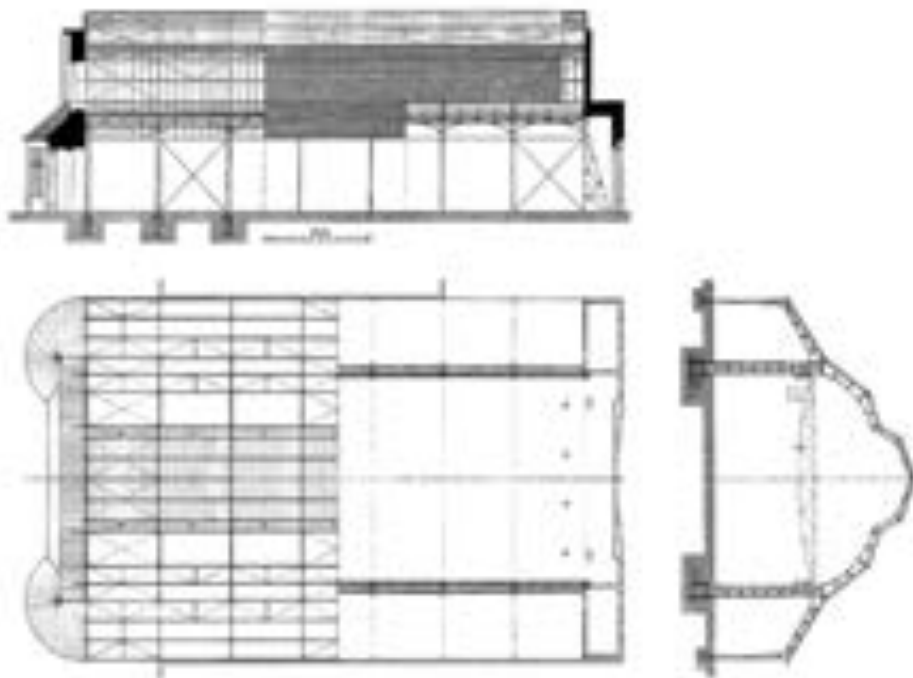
Kraftmaschinenhalle, Grundriss und Schnitte
